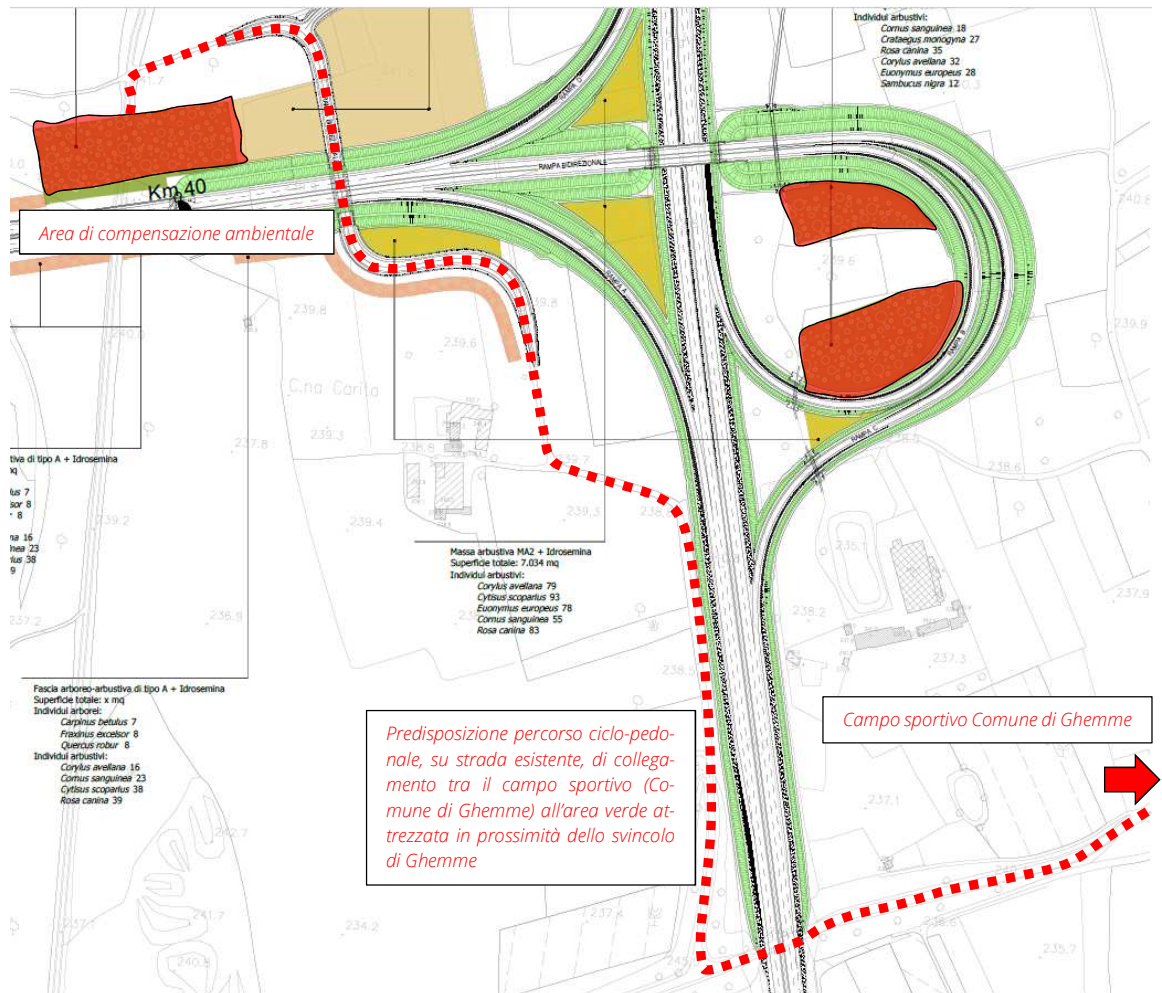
Stralcio planimetrico interventi di inserimento paesaggistico Svincolo di Ghemme
